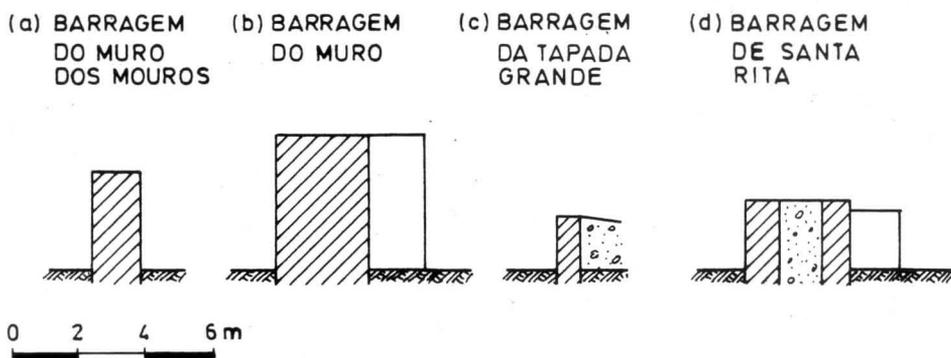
SECÇÕES TRANSVERSAIS TIPO DAS BARRAGENS ROMANAS A SUL DO TEJO: A) MURO DE SECÇÃO RECTANGULAR, B) MURO COM CONTRAFORTES A JUSANTE, C) MURO COM ATERRAMENTO A JUSANTE E D) DUPLO MURO COM ATERRAMENTO INTERMÉDIO E CONTRAFORTES A JUSANTE.
